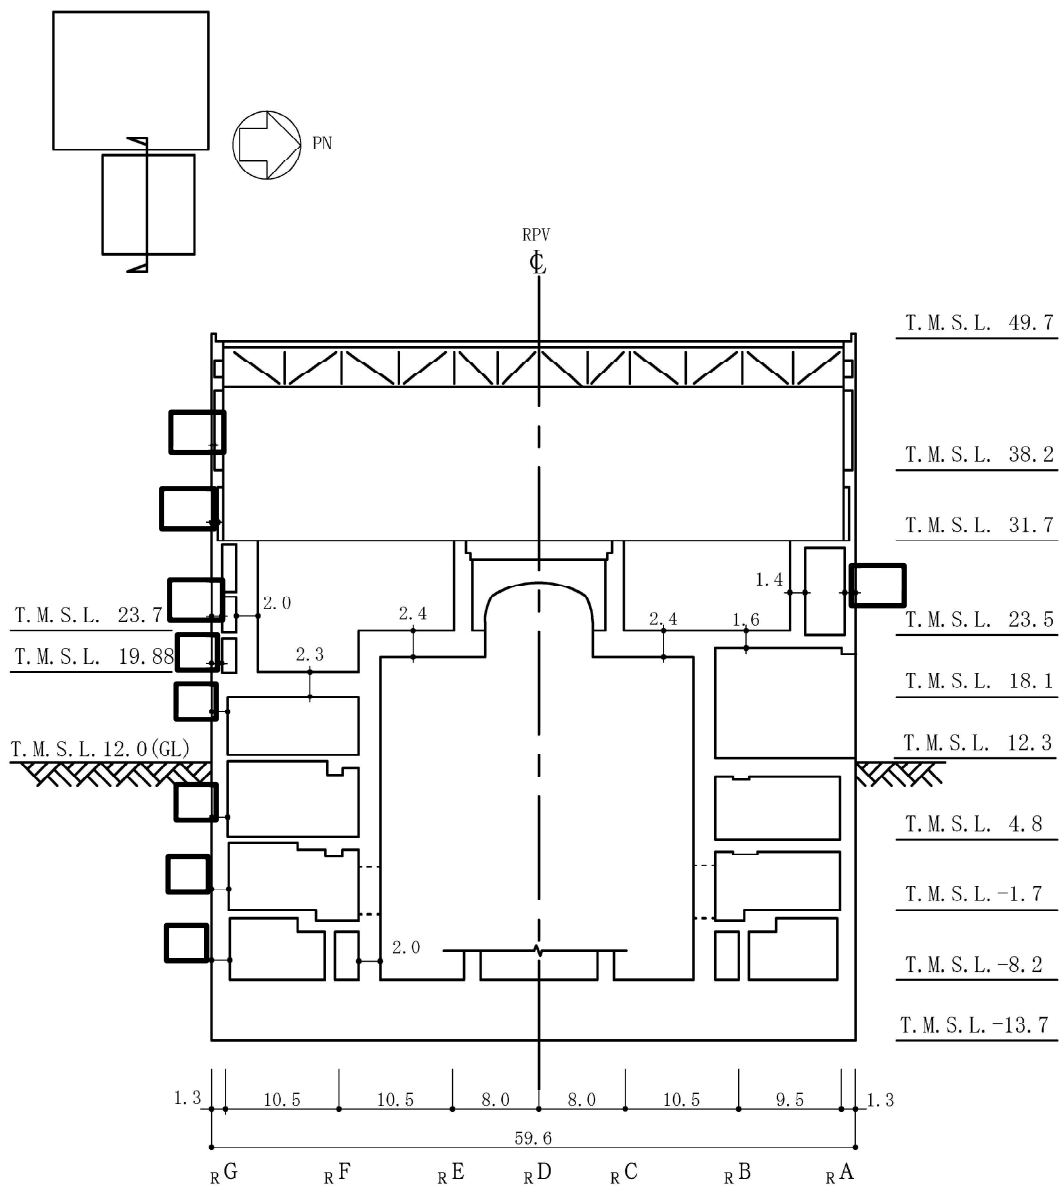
原子炉建屋の概略断面図 (EW 方向) (2/2) (単位 : m)
